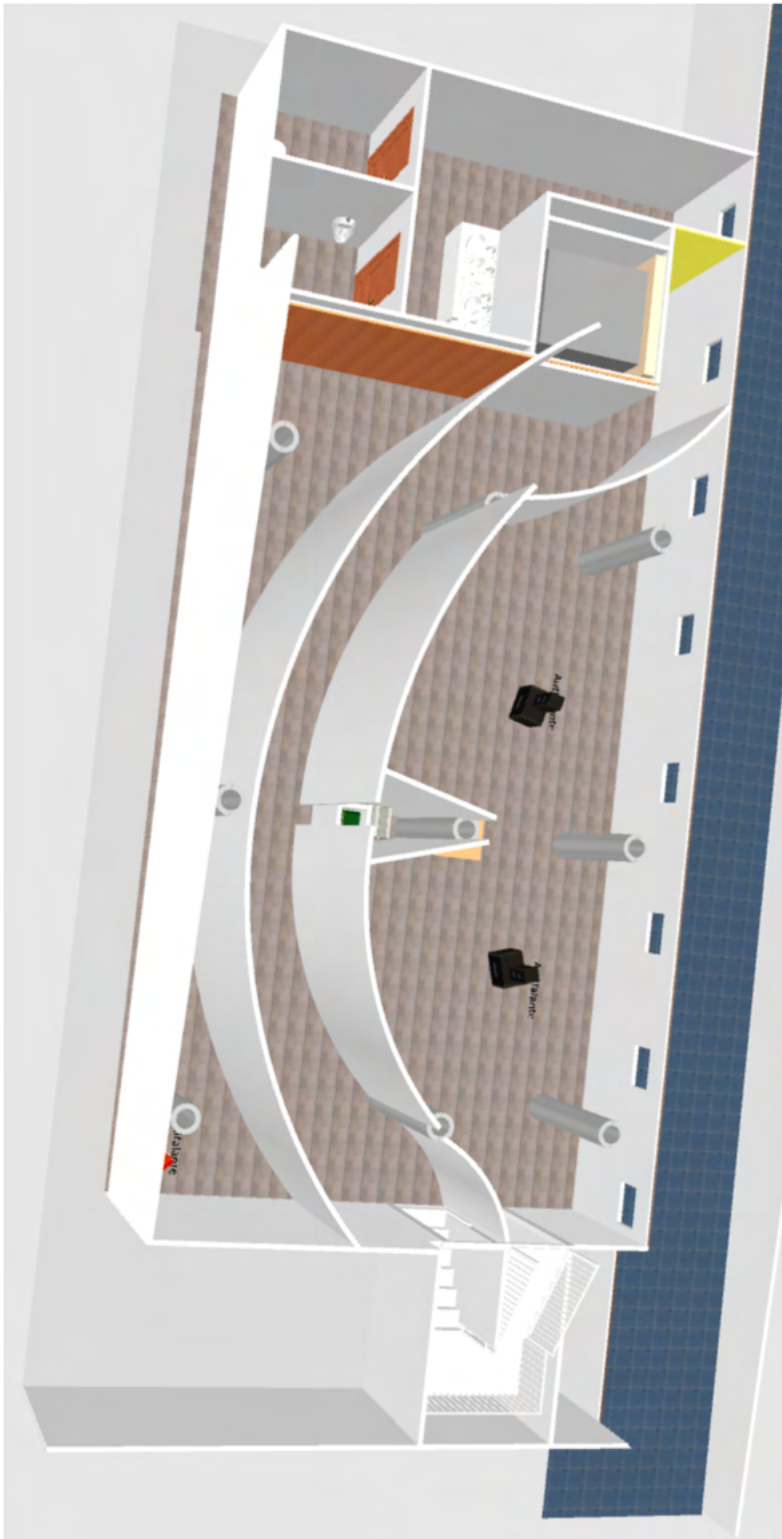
Planta da sala principal de protótipo. Cave da galeria de exposições *Trituraria*, Covilhã.
